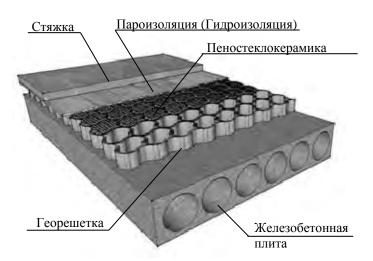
Вариант конструкции системы утепления по железобетонным плитам
